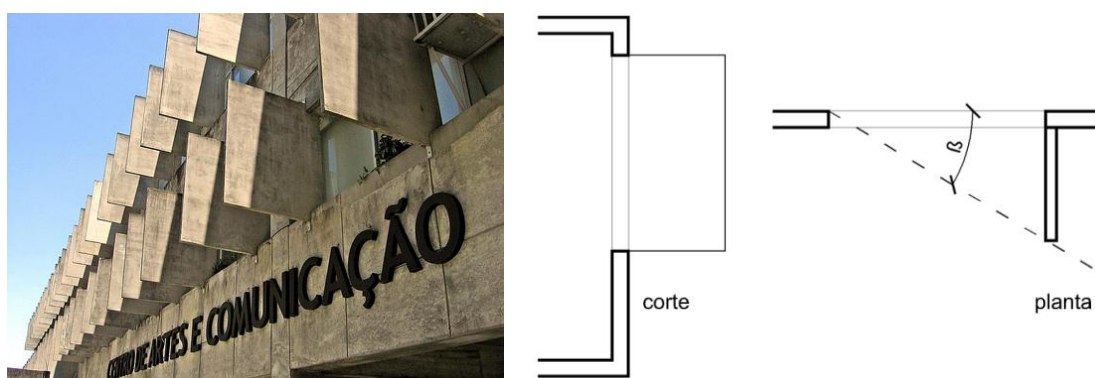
Exemplo de protetor vertical e esquema em planta e corte.
